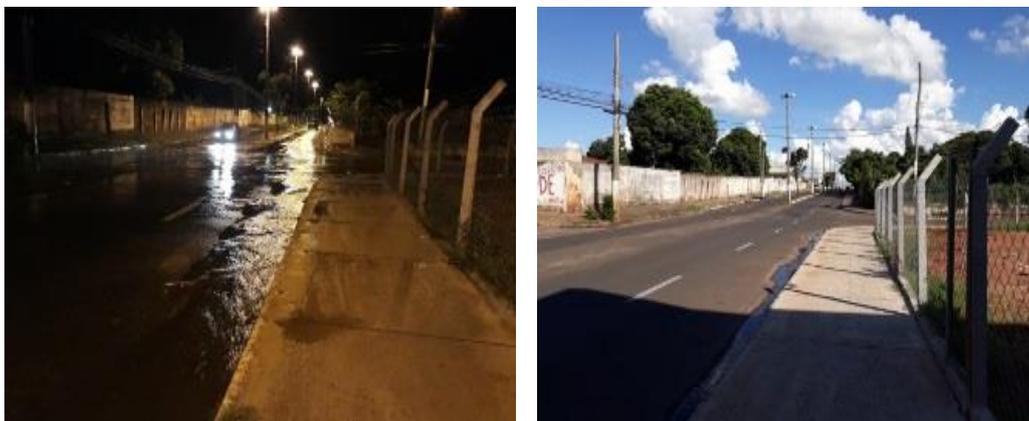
Rua Bahia. Plano de drenagem ineficiente; pavimento e sarjetas impermeáveis.
